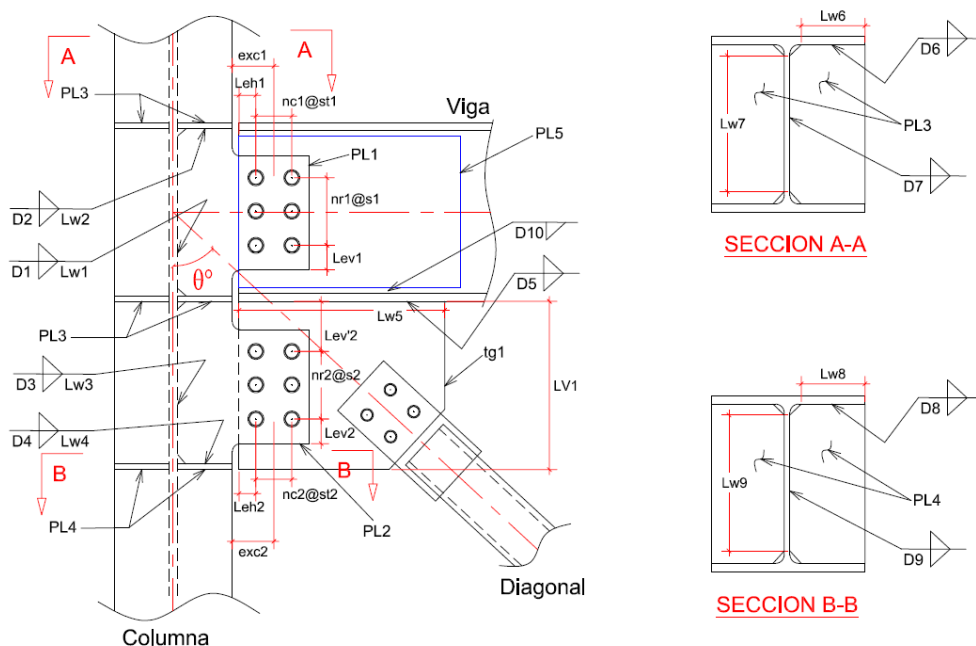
Esquema de conexión diagonal con viga y columna-Nudo
